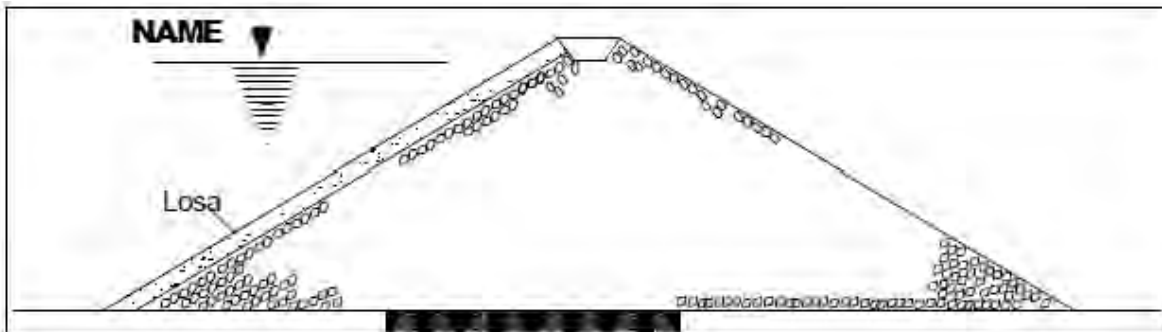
Presa de enrocamiento con losa de concreto o asfalto (cimentación rígida)
